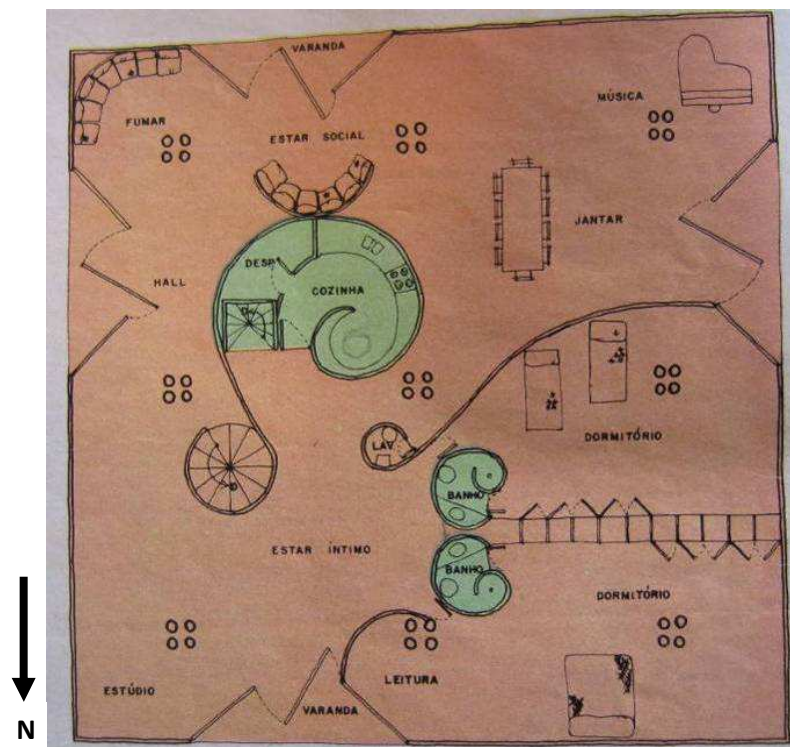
Residência Abraão Assad*: planta esquemática do pavimento superior.
